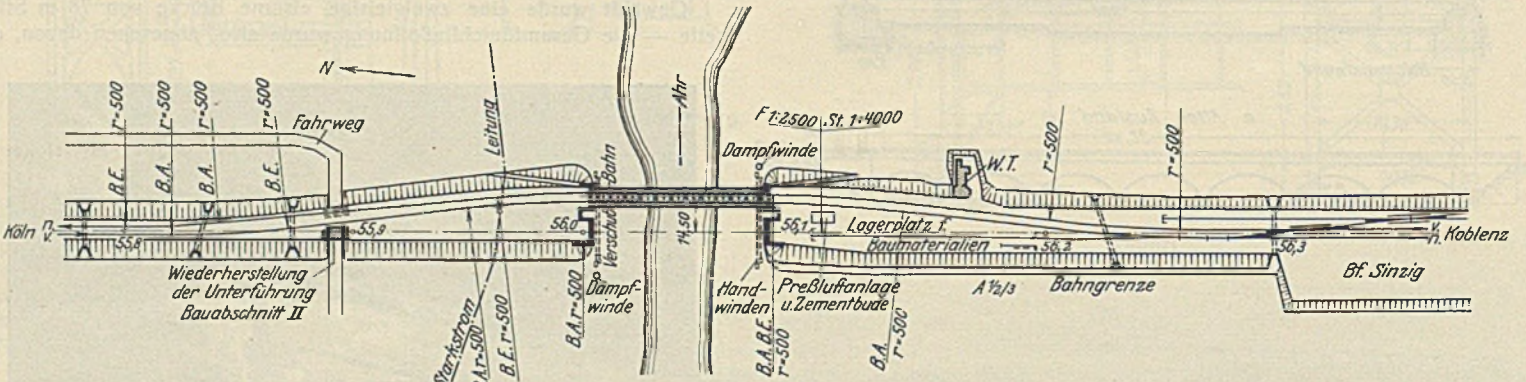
III. Bauabschnitt: Abbruch der alten Brückengewölbe und Herstellung der endgültigen Widerlager.
